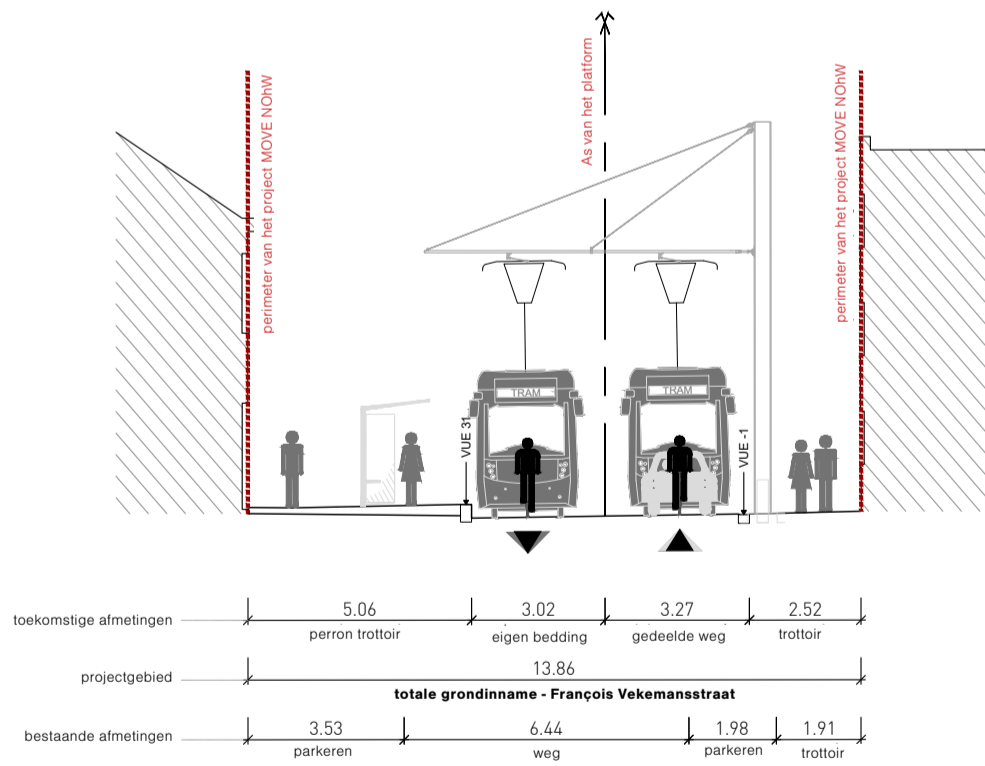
Secteur 3 - Zavelput - Coupe 1
